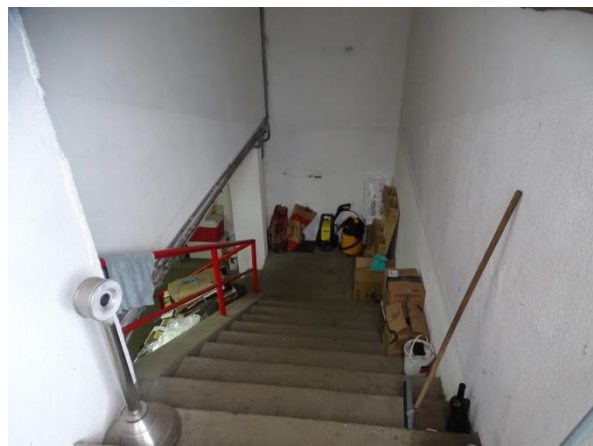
Vista da escada de acesso ao subsolo do galpão.
